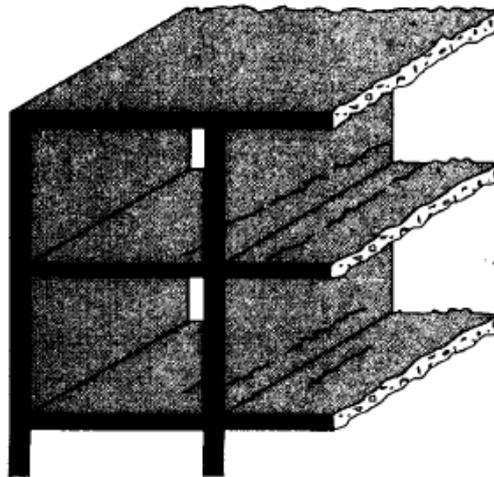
FISURAS DE FLEXIÓN.
